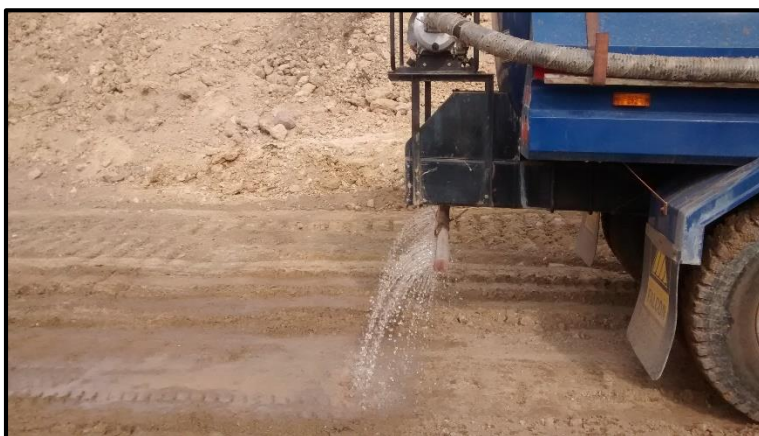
Riego de vía sin pavimentar – PTAP Los Angelinos
